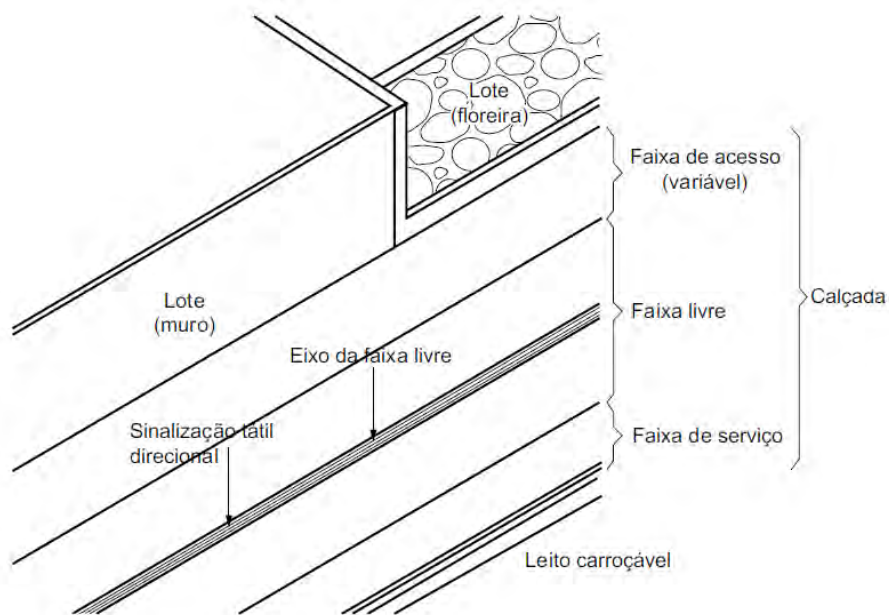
Alinhamento de lote não edificado, entre outros lotes edificados
